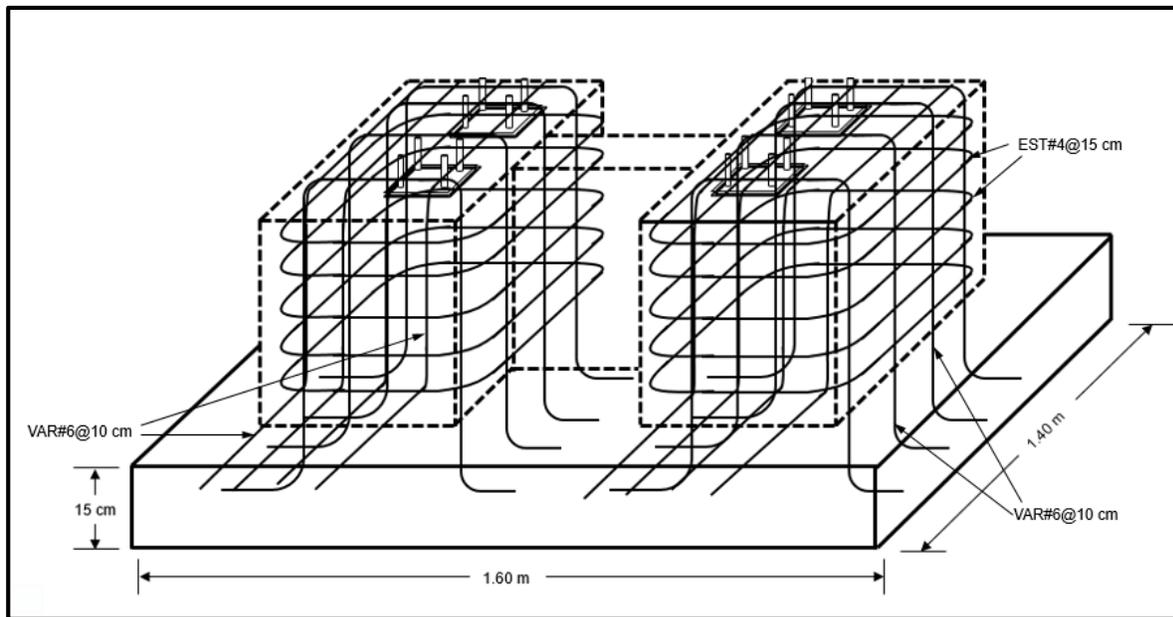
Armado de los dados de zapata aislada parte de la Cimentación de la Estructura Mayor
